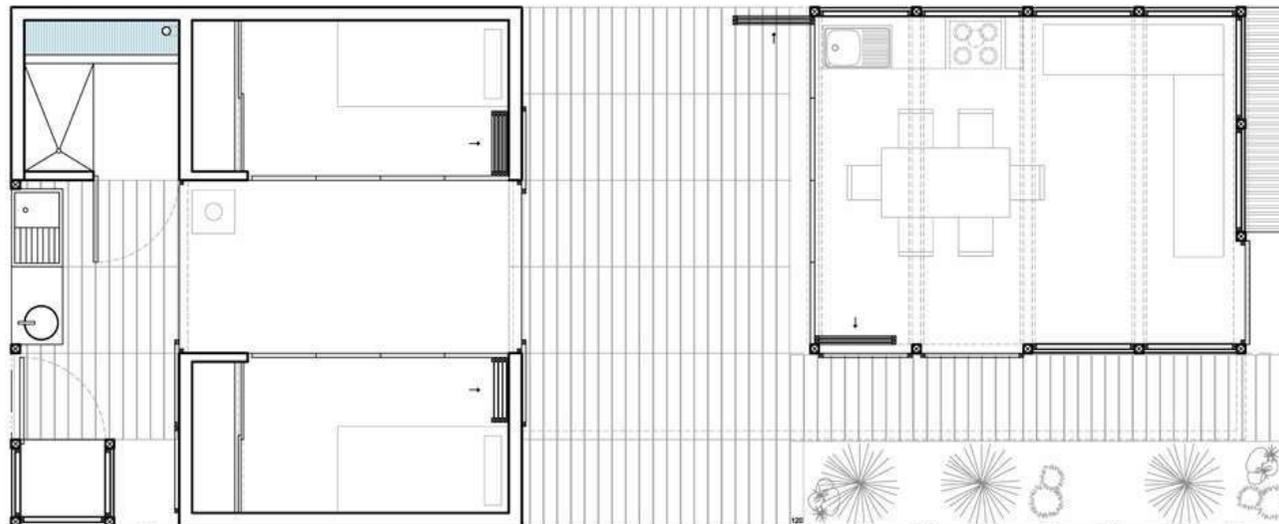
Planta arquitectónica. Comunidad Vivex., Monterrey, Nuevo León.
